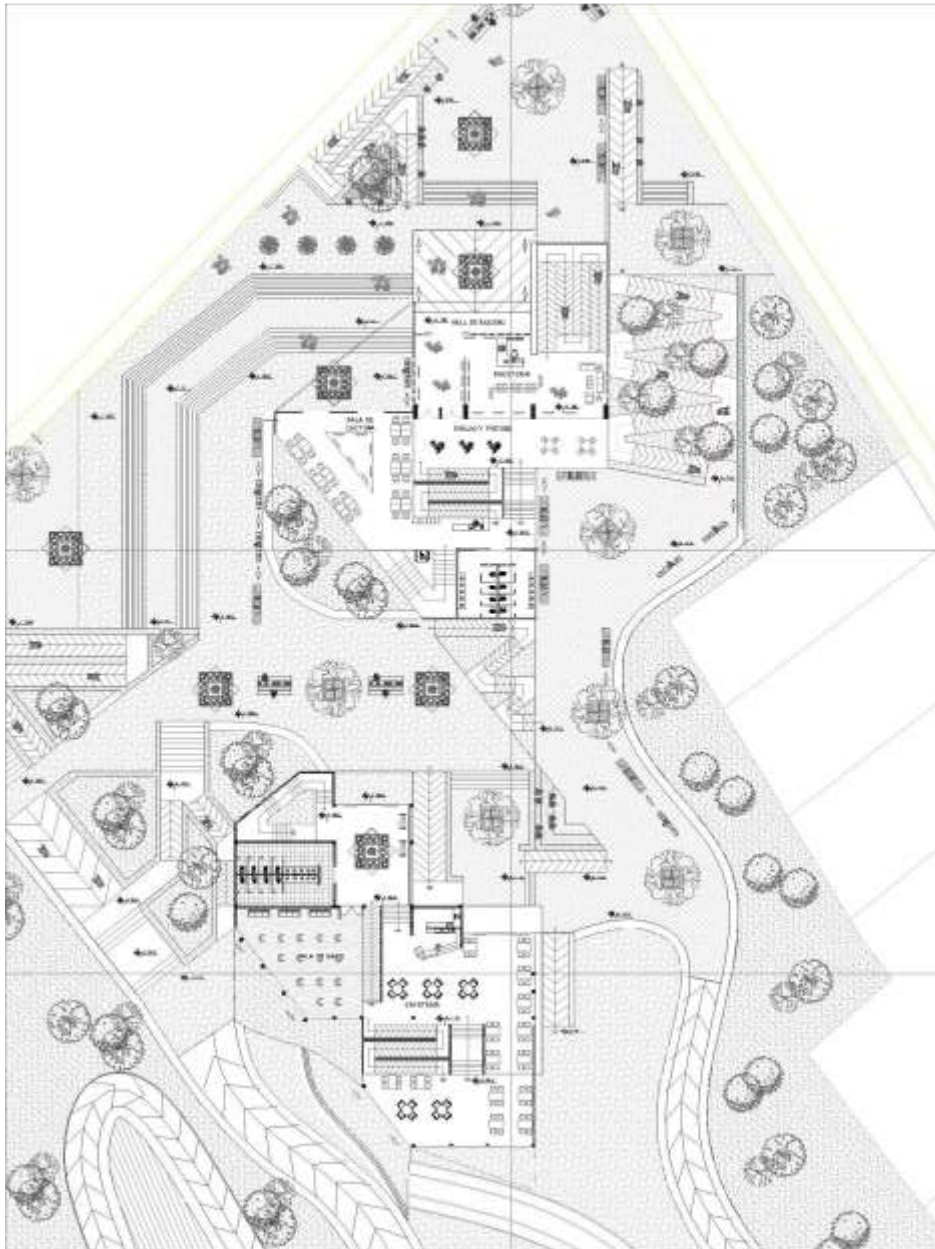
Planta de cubierta y emplazamiento de equipamiento
